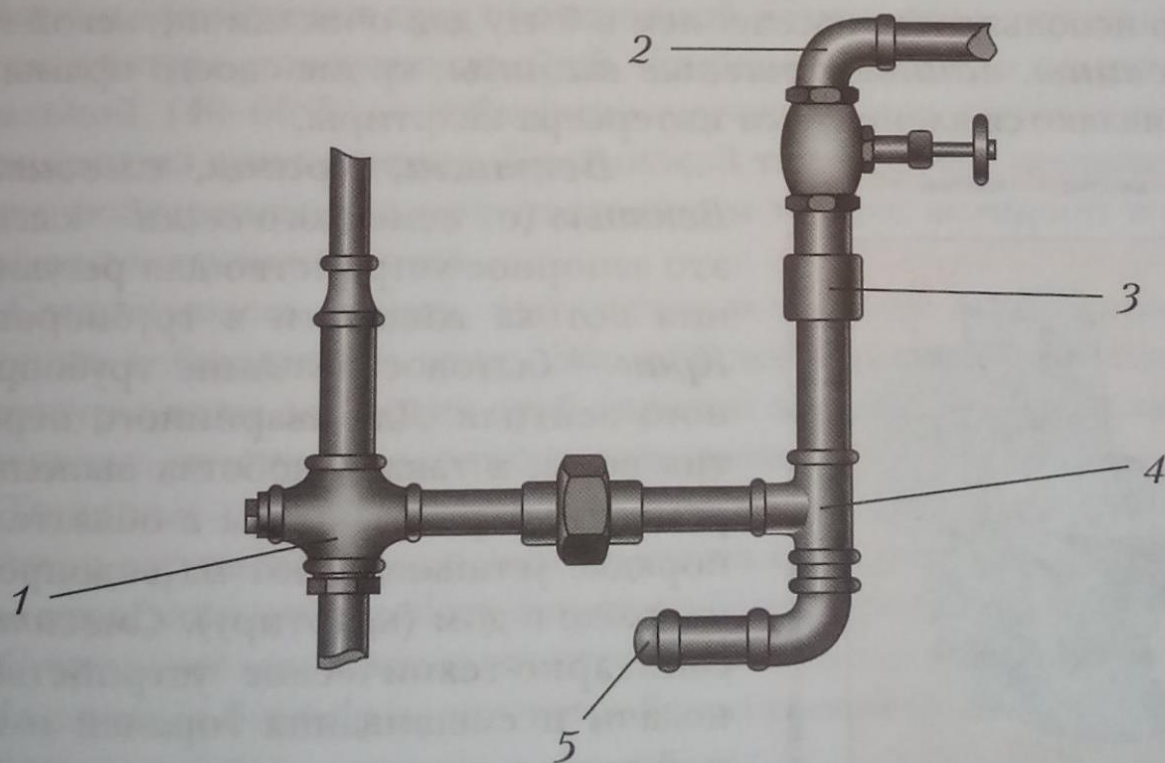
Монтажные соединительные детали (фитинги): 1 — крестовина; 2 — угольник; 3 — муфта; 4 — тройник; 5 — пробка
